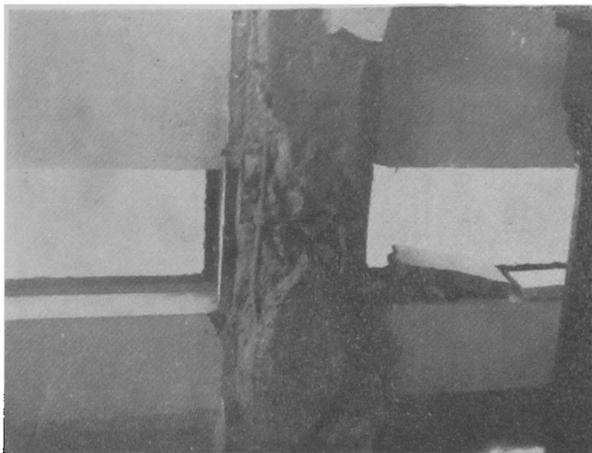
Detalle en daños en la parte inferior de planos verticales, fachada lateral de la misma iglesia
